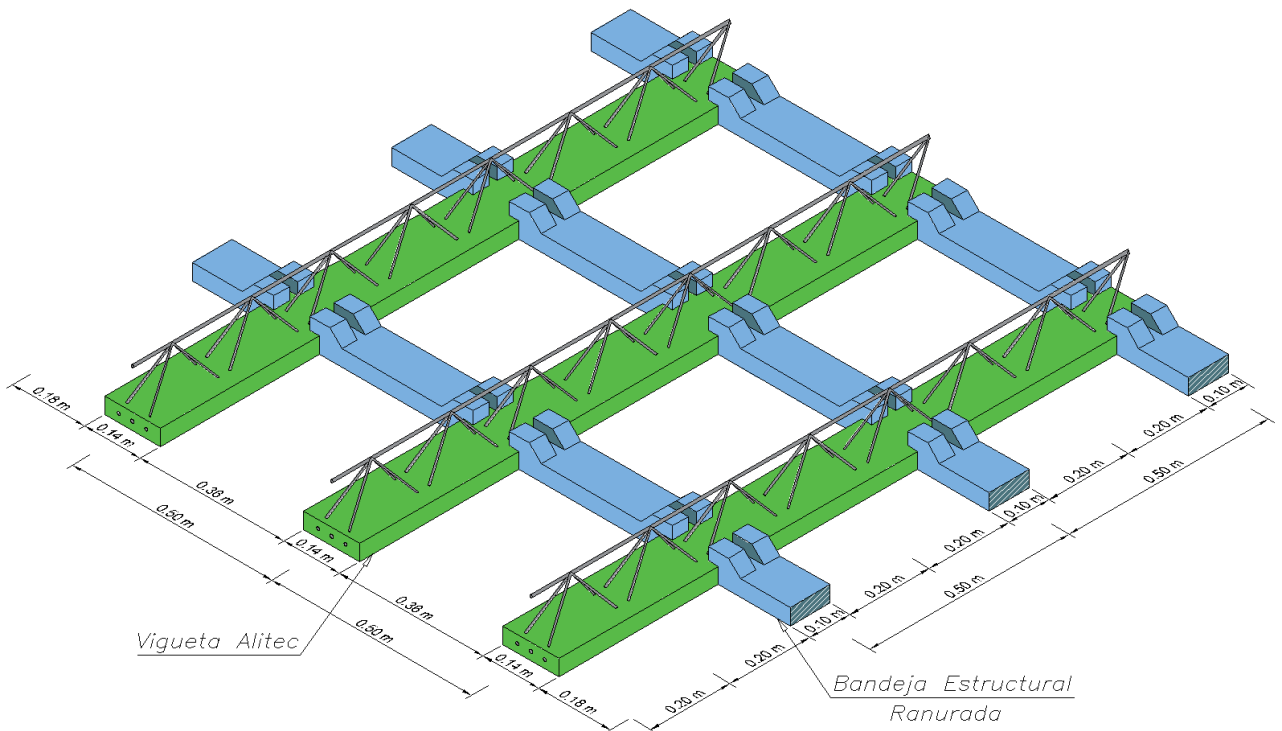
Vista Isométrica del sentido de las viguetas Alitec y bandejas estructurales ranuradas de la Losa Aligerada Bidireccional Alitec.
